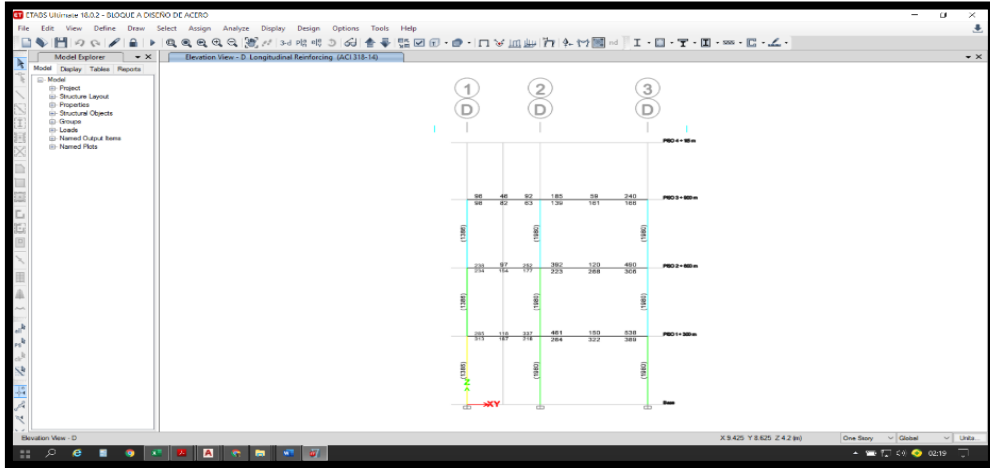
Bloque B - Acero longitudinal en el eje elevación eje D-D
